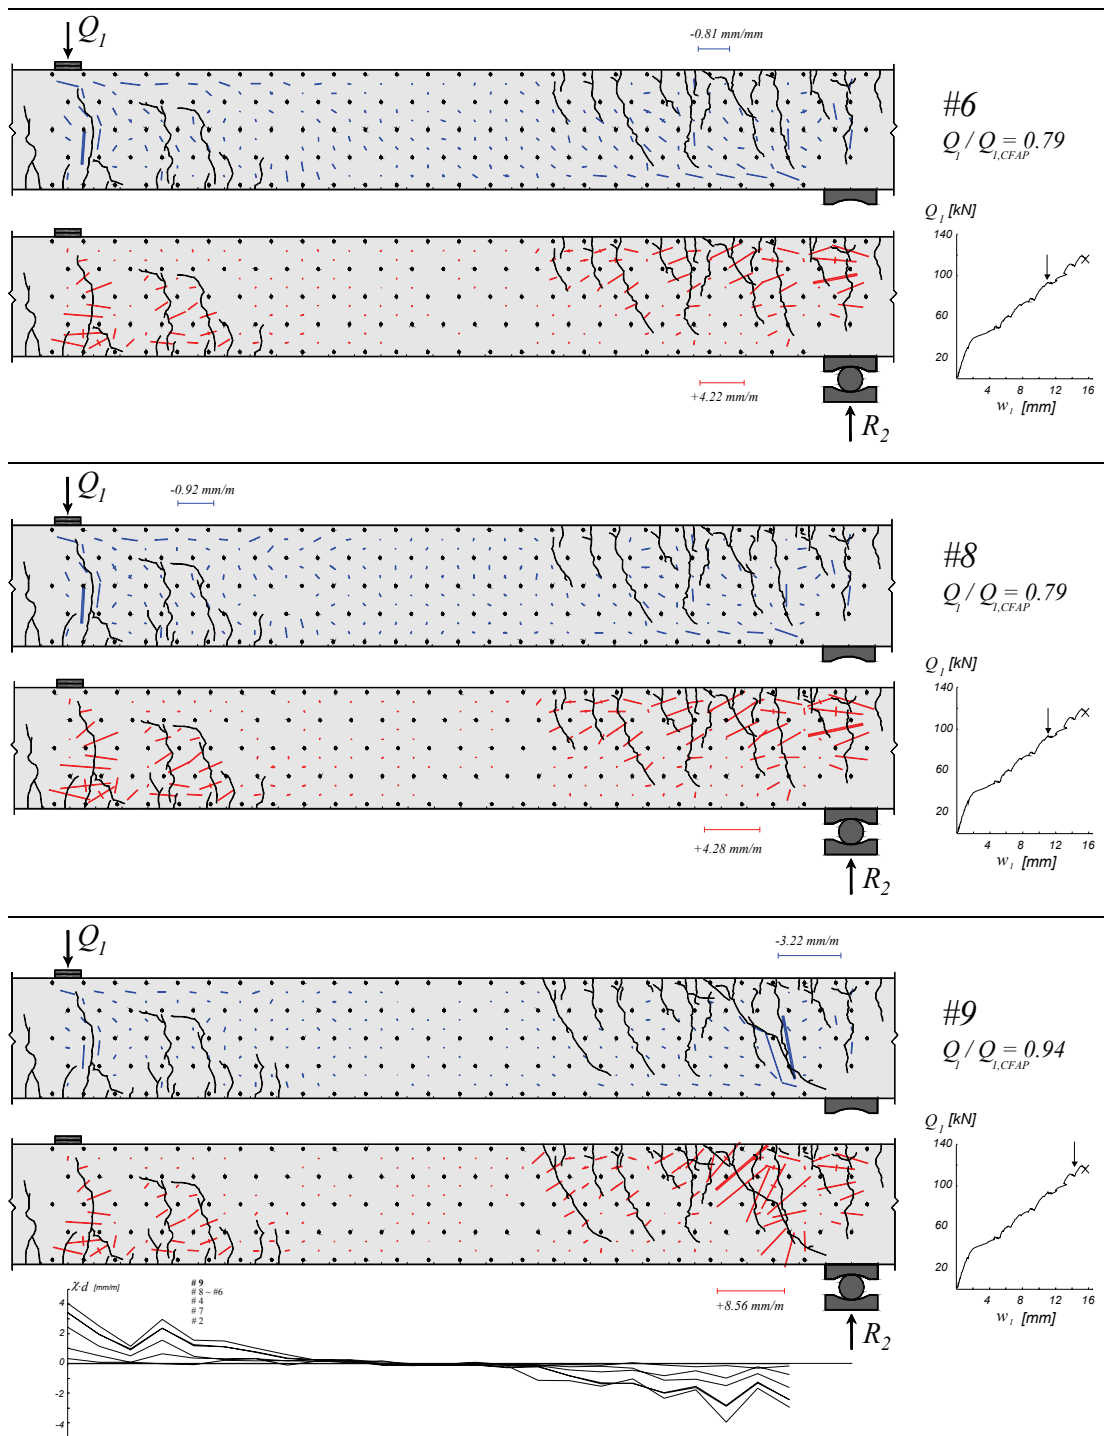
Poutre SR6: déformations principales, fissuration et courbures
